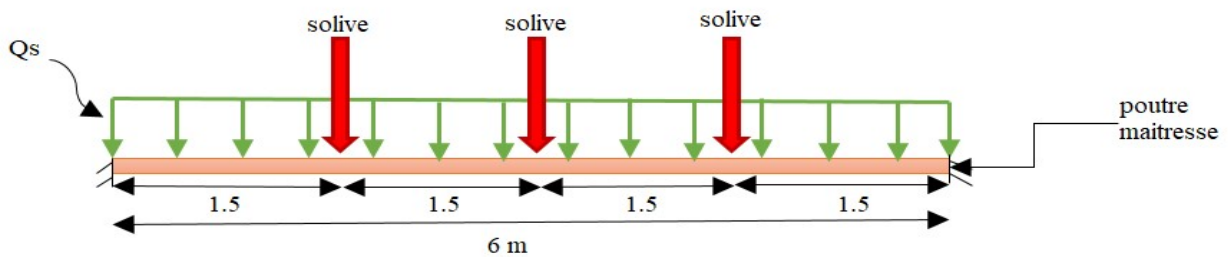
Schéma statique de la poutre maitresse sous chargement.
